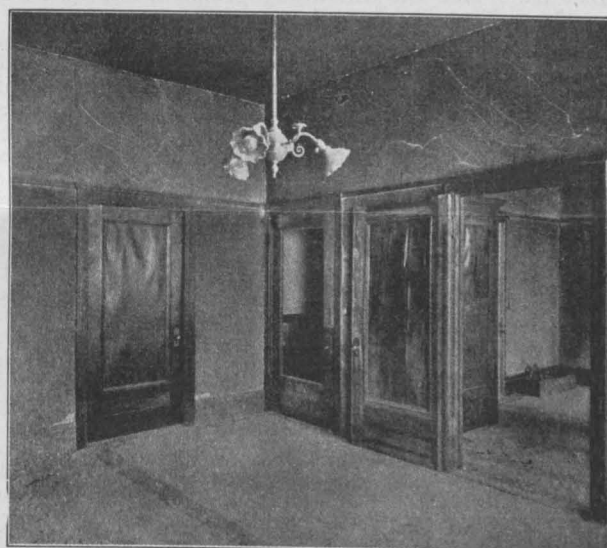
Typische Erdbebenrisse in Eisenbeton-Wänden.
